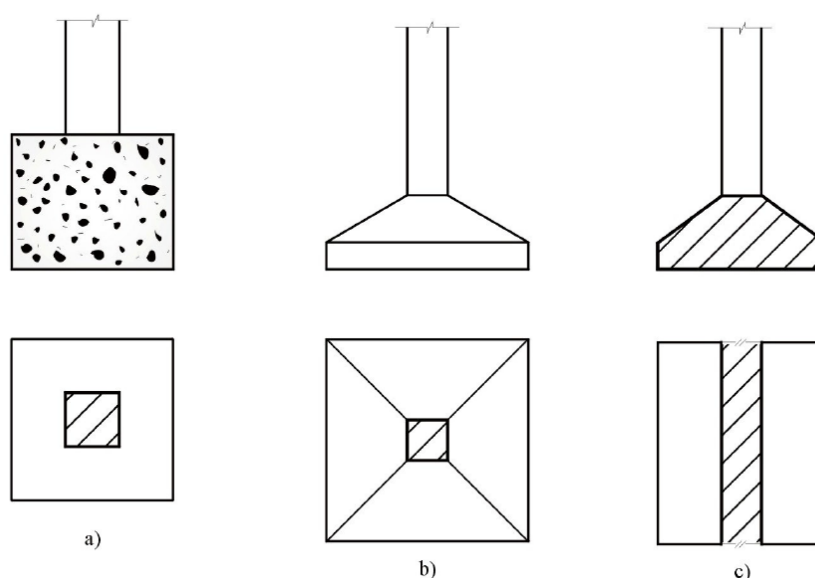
Fundações diretas: a) bloco isolado de betão ou alvenaria de pedra; b) Sapata isolada; c) Sapata corrida. (Vitório, 2002)
